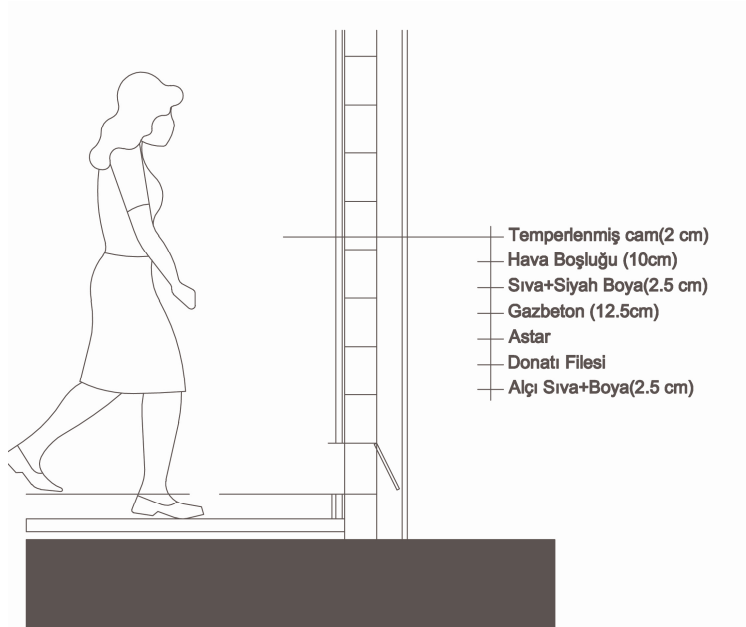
Trombe duvarı beton kullanım detayı
